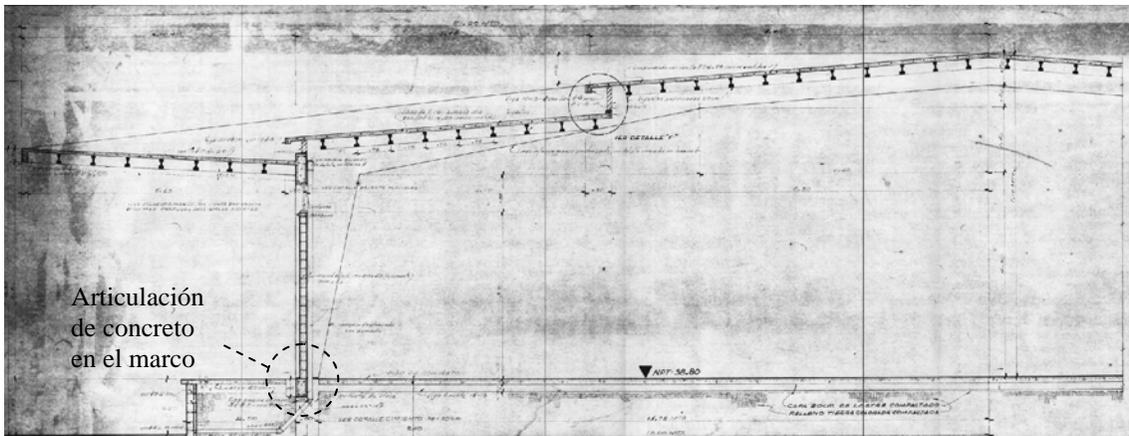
Sección de las bodegas de concreto preesforzado.
